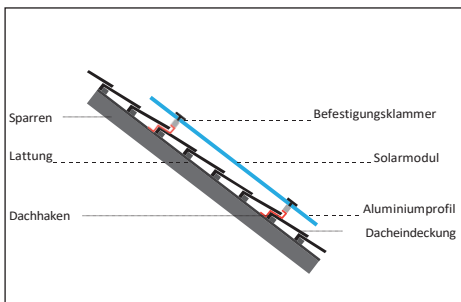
Aufdachmontage des PV-Moduls mit Dachhaken am Sparren.
